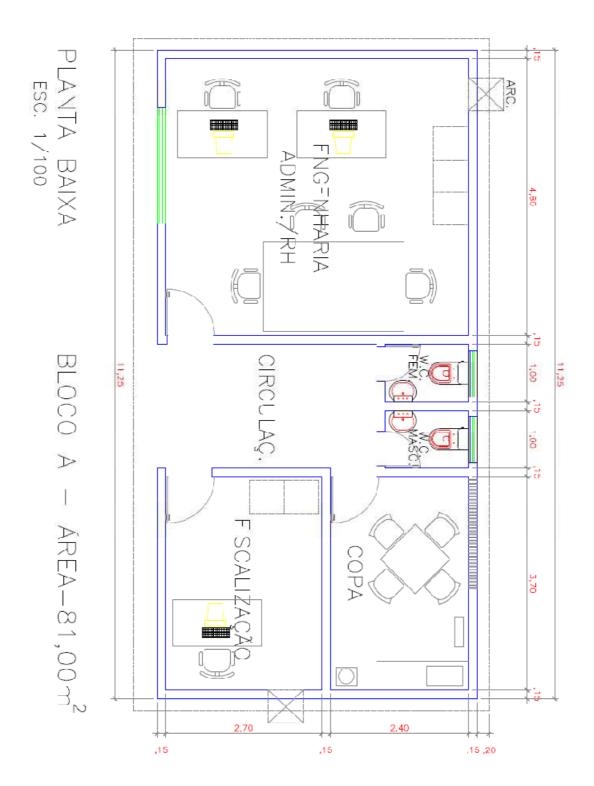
Planta baixa do primeiro bloco do barração de 50 pessoas.
